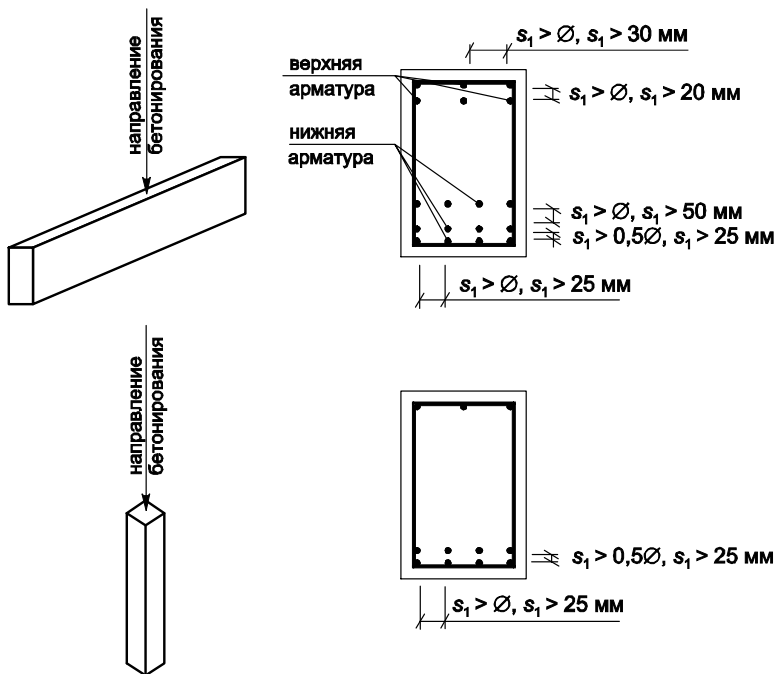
Минимально допустимые расстояния между продольными стержнями арматуры в зависимости от положения конструкции при бетонировании
